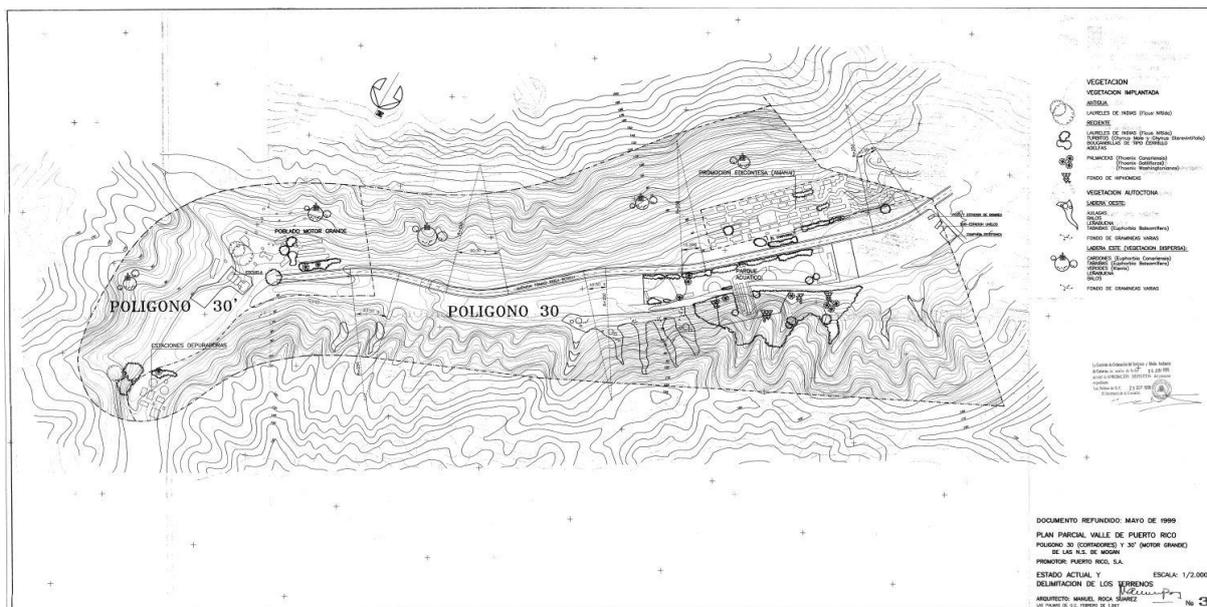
Plano del estado actual y delimitación de los terrenos. Fuente: Plan Parcial Valle de Puerto Rico. Polígonos 30 (Cortadores) y 30' (Motor Grande) de las NNSS de Mogán.
